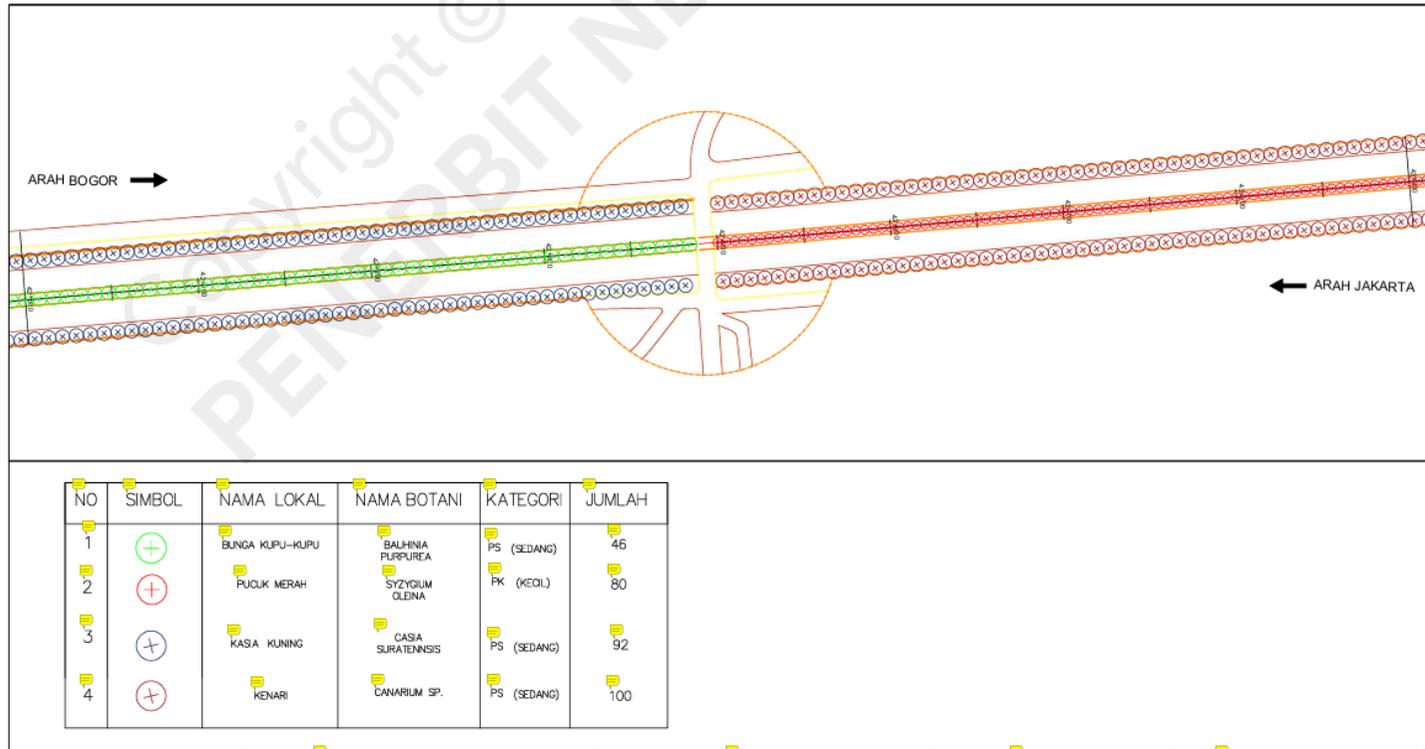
Rencana RTH pada Ruas Km 41-41,7
